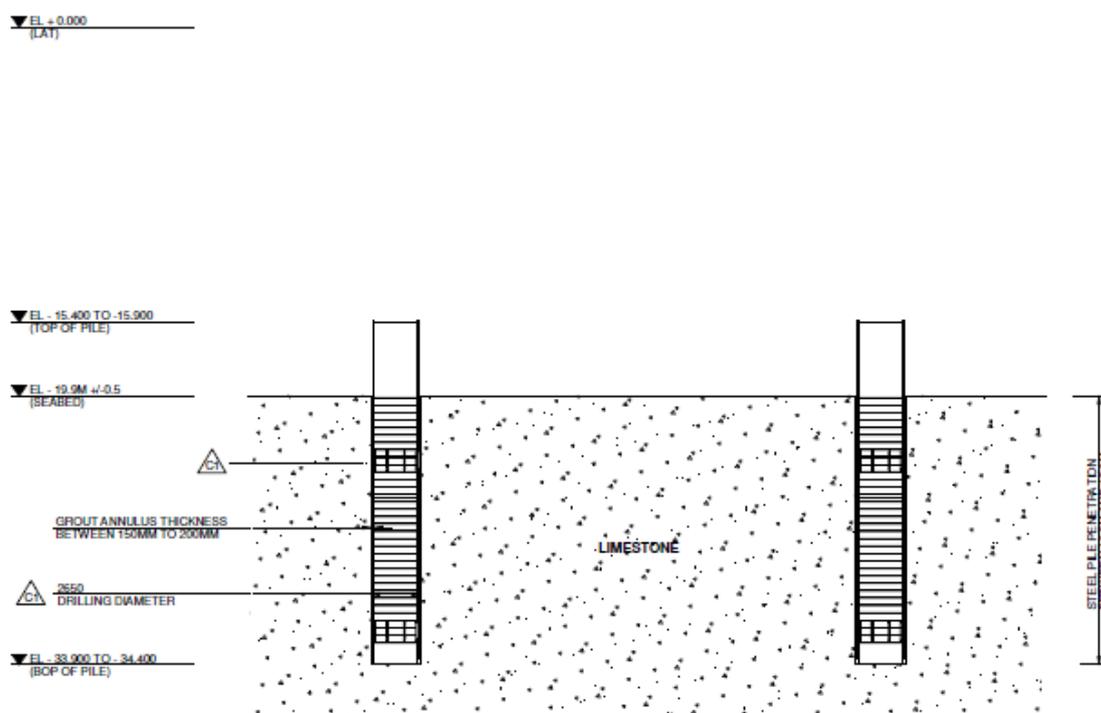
Plan d'implantation des pieux destinés à recevoir la fondation du poste électrique
